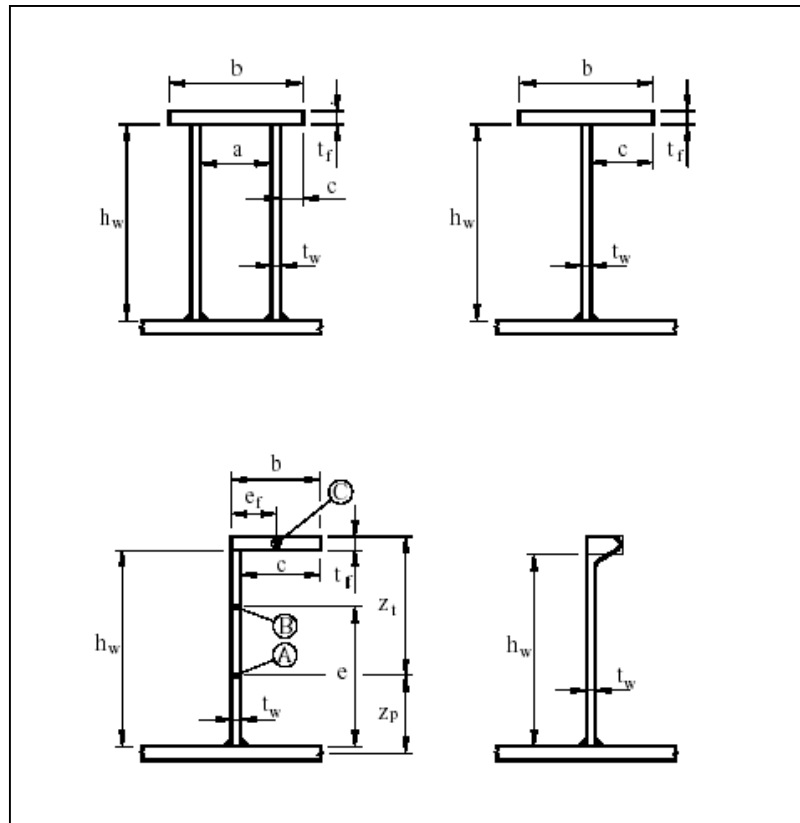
Seções transversais típicas para vigas e enrijecedores
